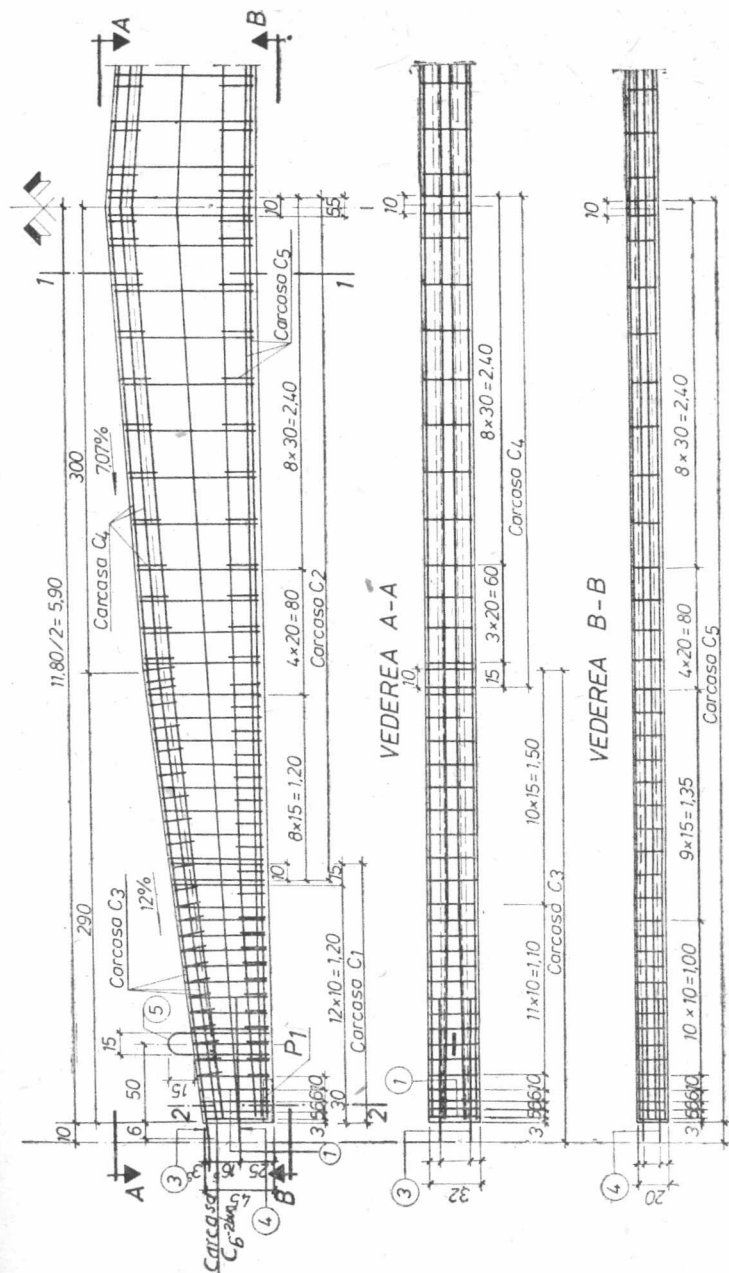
a. Armarea grinzii precomprimate de 12,00 m (G 12) cu toroane, pentru hale cu elemente de travee de 6,00 m. Plan armare.
